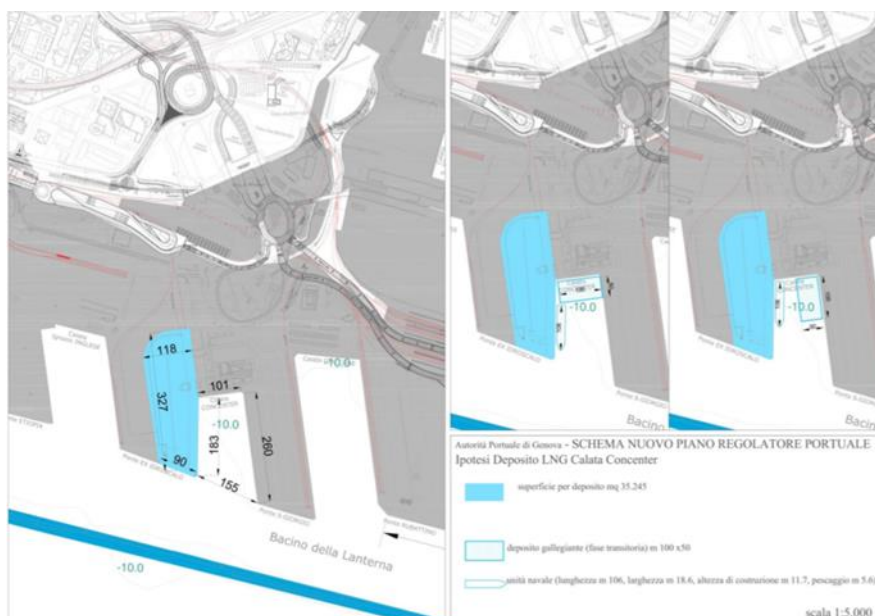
Layout ipotesi progettuale 5 (Fonte: report “Engineering studies, final version” - 2016).
